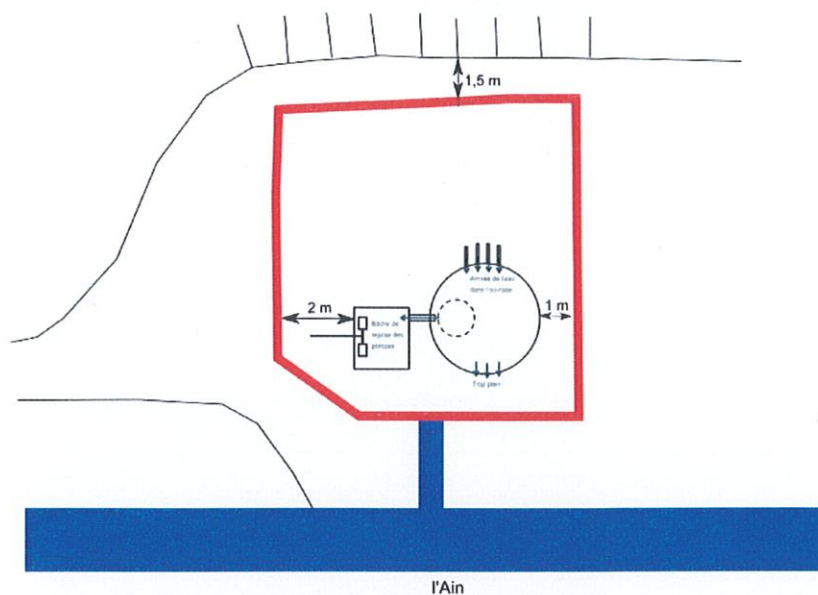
Proposition de PPI autour de la source de la Roche – Plan
